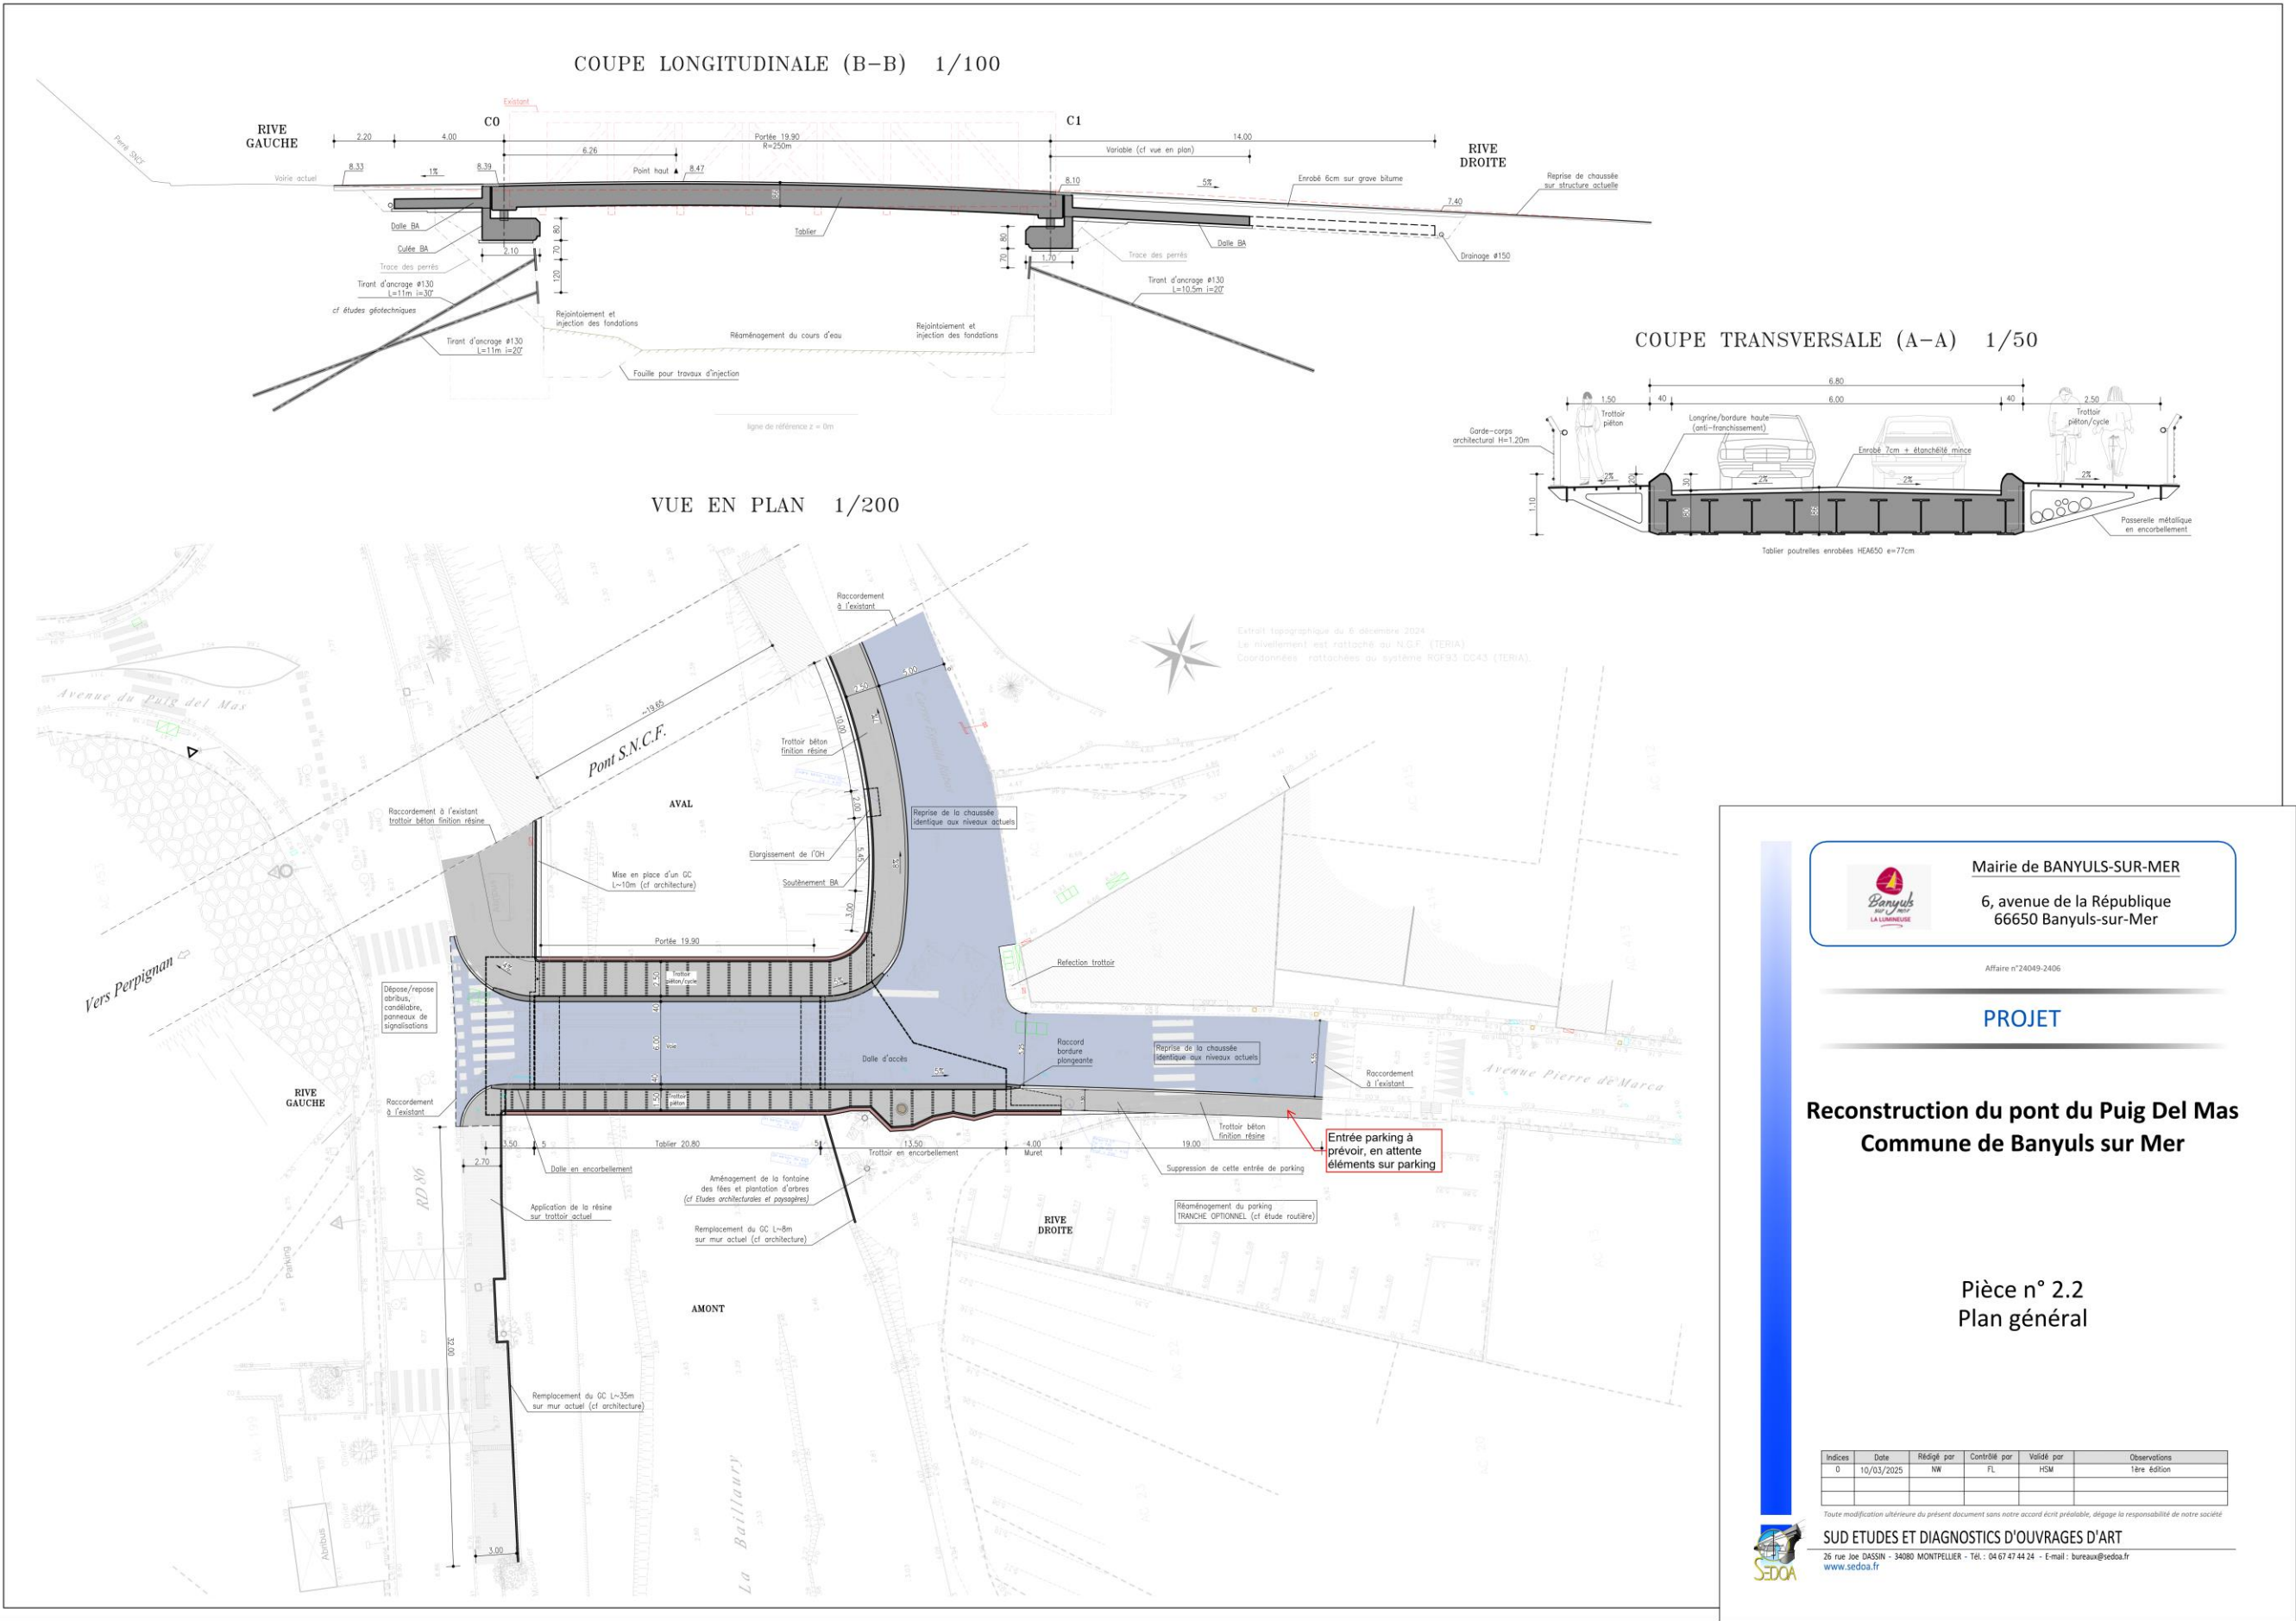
Plan général projet (source : SEDOA, DCE, mai 2025)
